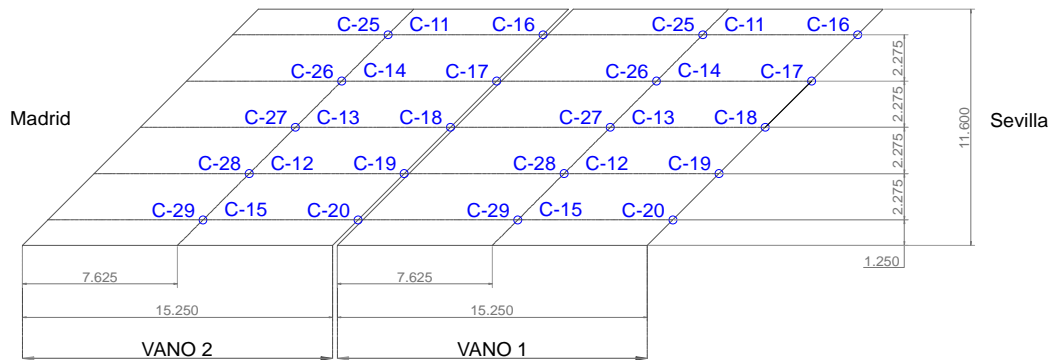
Planta de disposición de los aparatos de medida en la prueba de carga de Arroyo Bracea.
